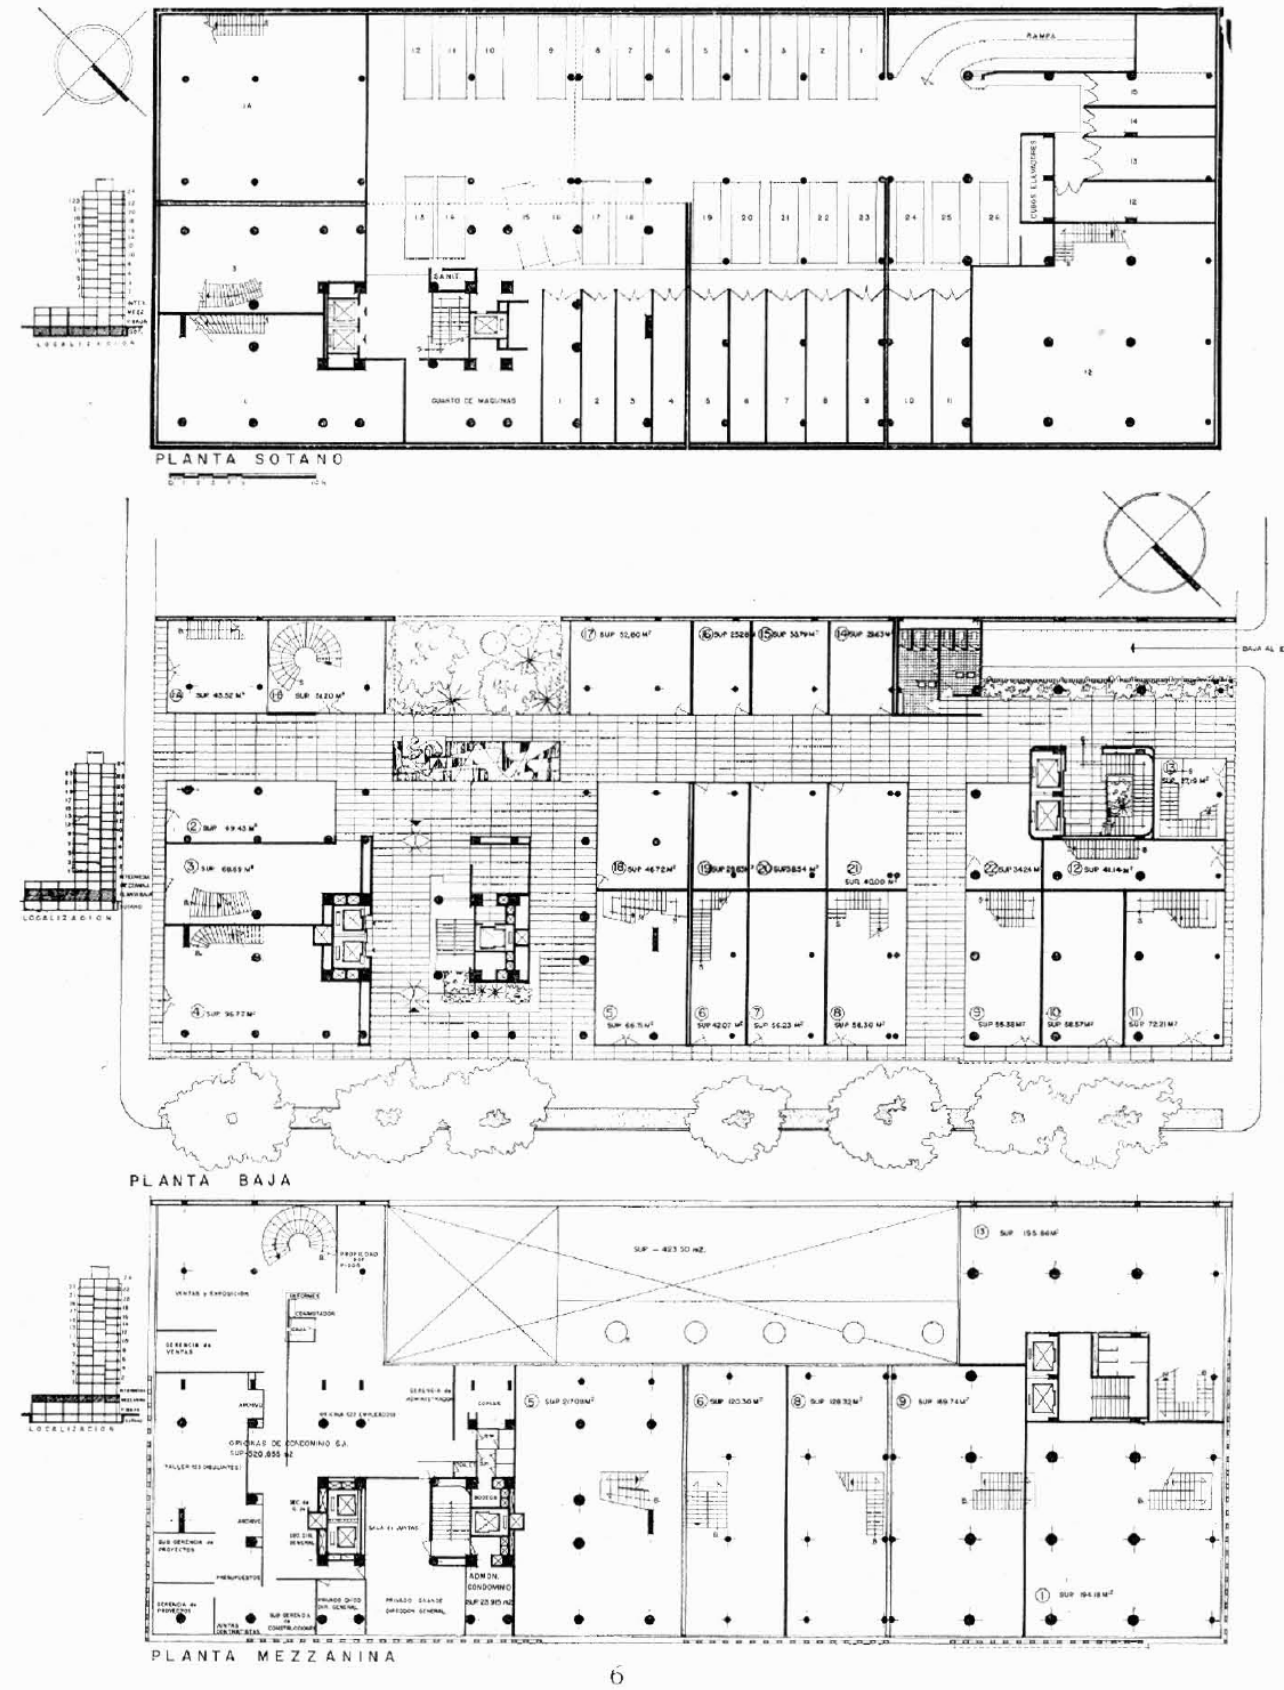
Planos arquitectónicos de la planta sótano, planta baja, y planta mezzanina.
